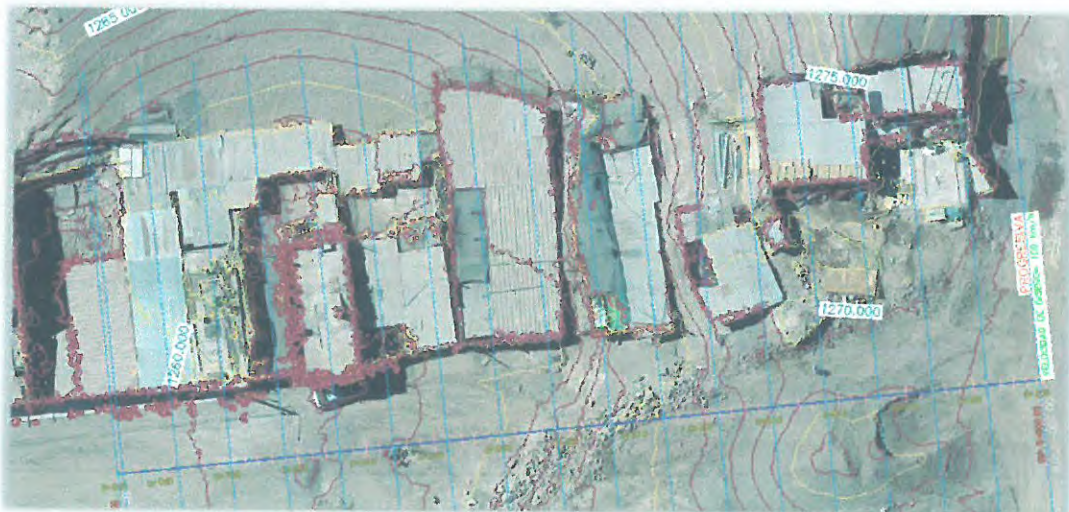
Vista aérea con topografía pendiente oeste este Lt. 15 Mz. F sector 2B
